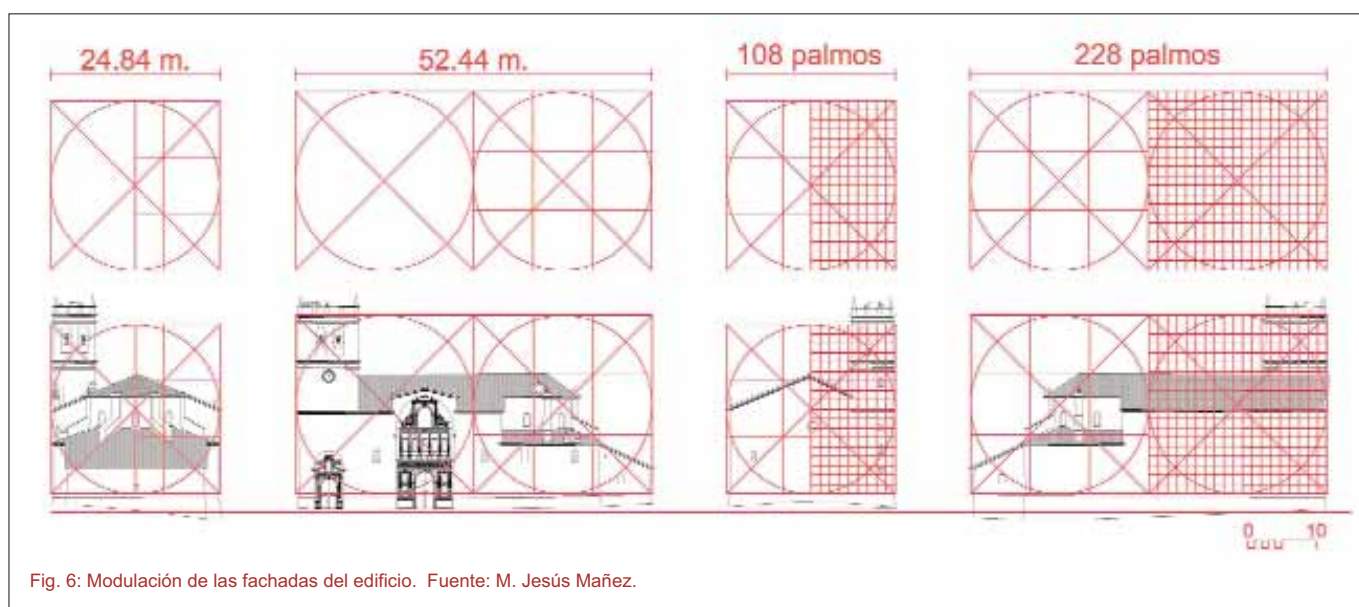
Modulación de las fachadas del edificio. Fuente: M. Jesús Mañez.
